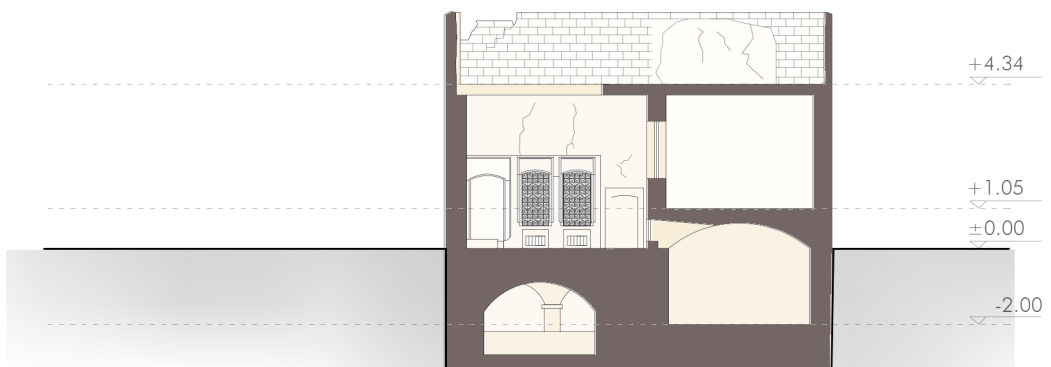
Sezione B-B della casa 9. Scala 1/200
